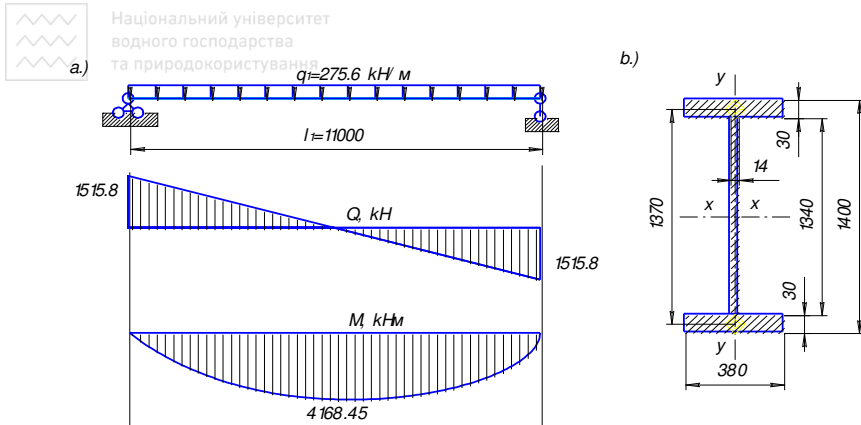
Розрахункова схема головної балки з епюрами Q і M (а) та поперечний переріз балки (б).
